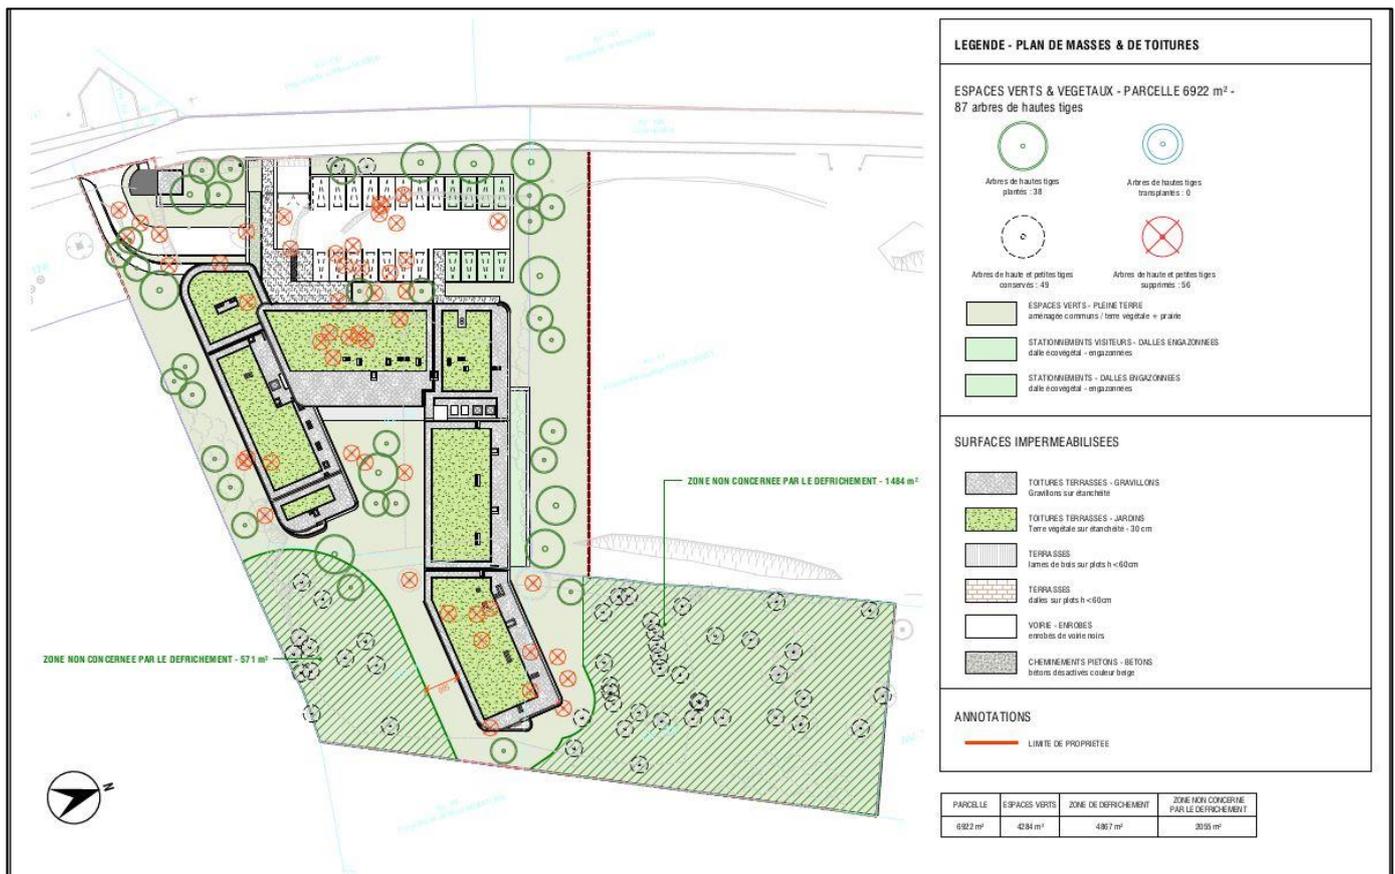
Plan de masse, plan paysager et zone de défrichement sur la zone d'étude
